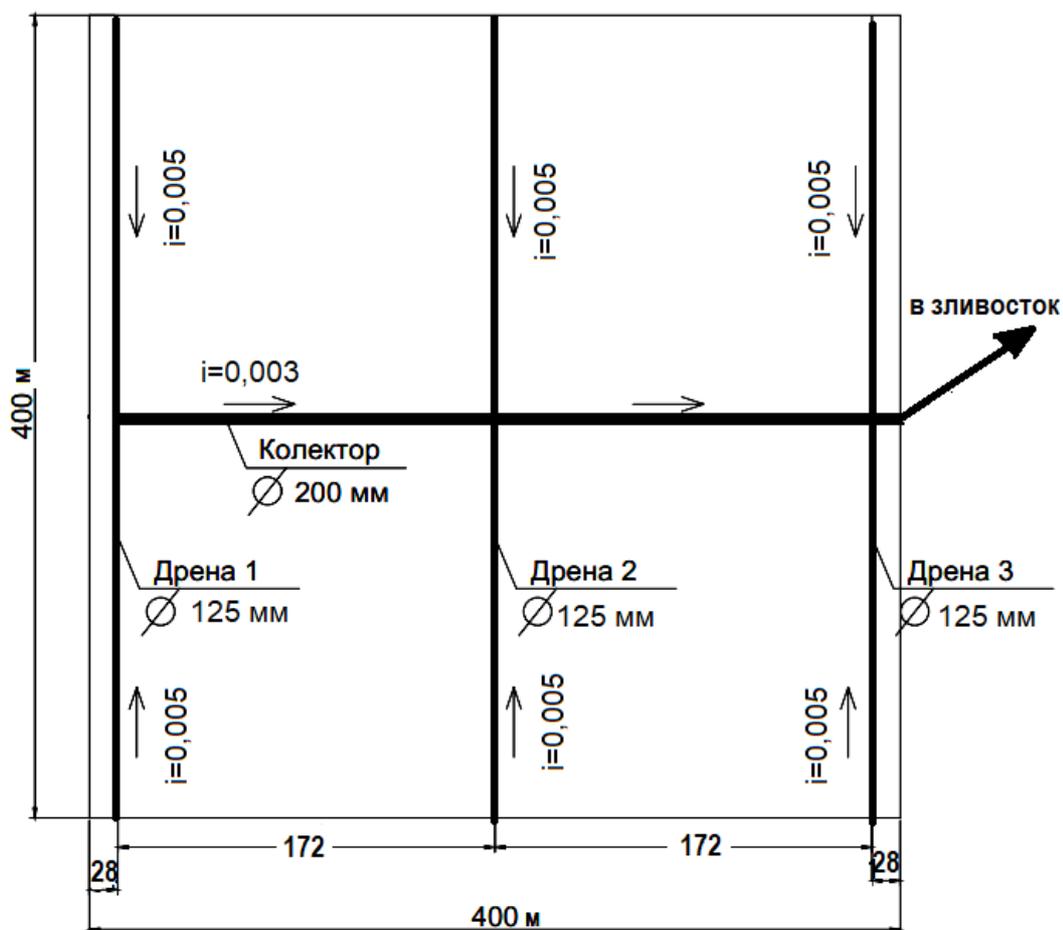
Схема дрен в плані (приклад 2)
